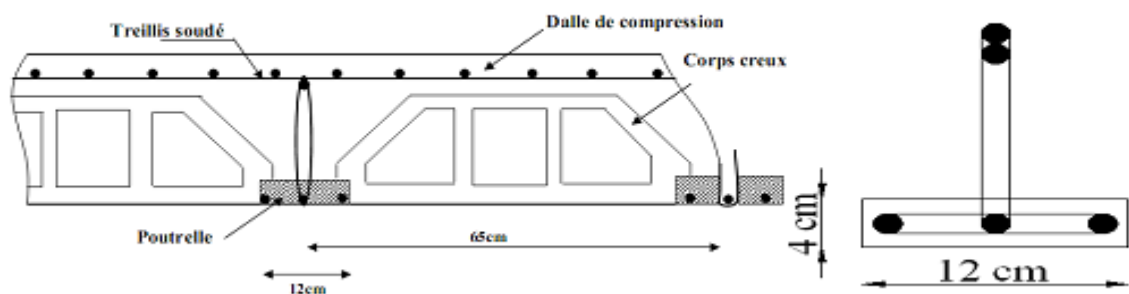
Coupe verticale d'un plancher en corps creux. Figure III.14: poutrelle.
